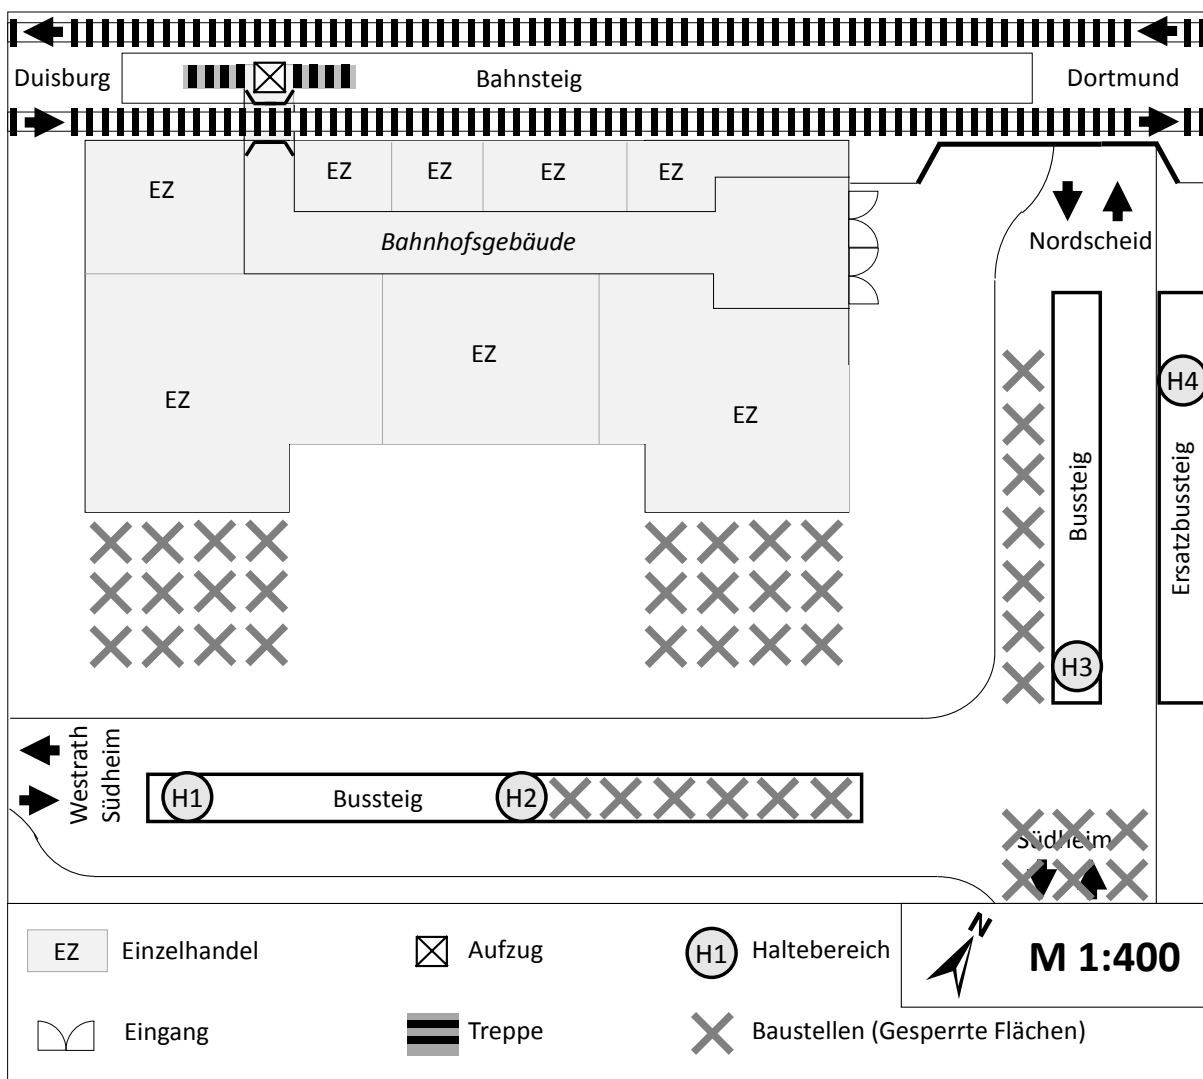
Lageplan des Bus- und Bahnhofs
